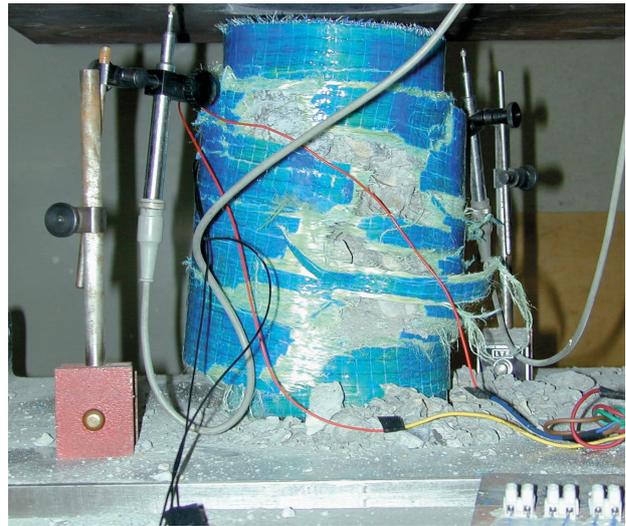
Prove di rottura a compressione di pilastri in c.a. confinati con SikaWrap® FIB
